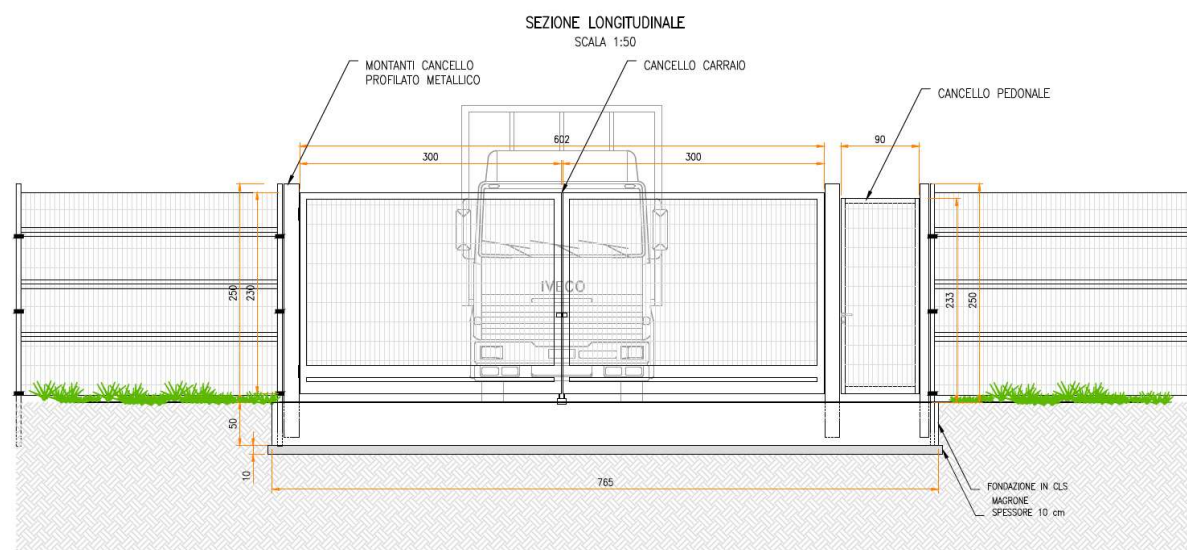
Sezione longitudinale accesso carraio e pedonale
